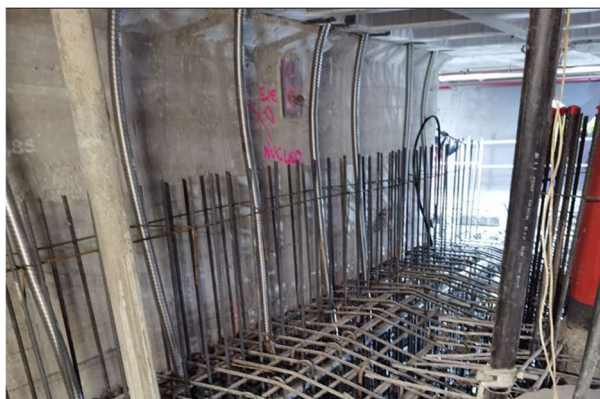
Fase de arranque de postesado vertical en refuerzo de muros desde cimentación.
